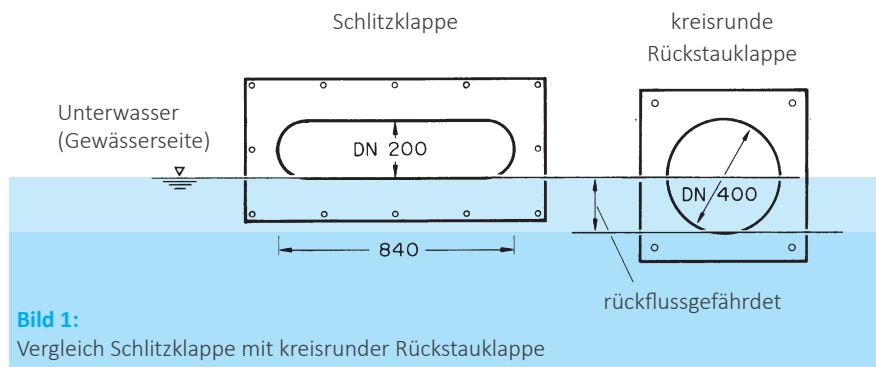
Vergleich Schlitzklappe mit kreisrunder Rückstauklappe
